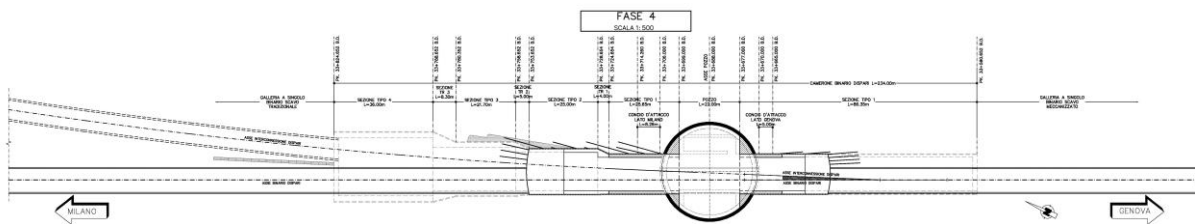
Avanzamento piena sezione lato Genova e Milano
